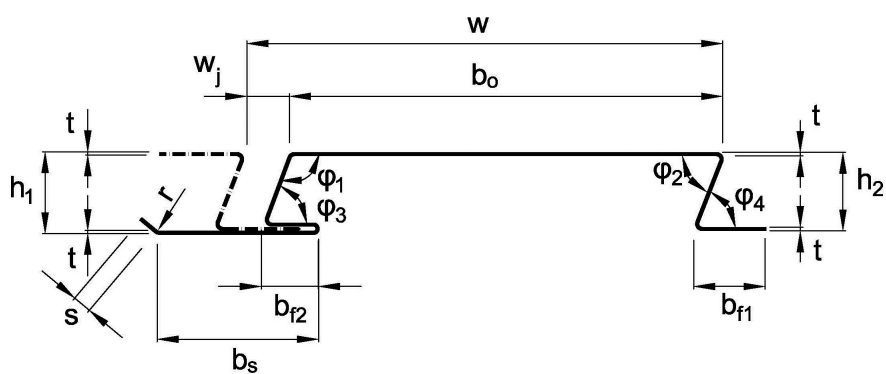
Section transversale de profilés de bardage / façade avec joint creux
